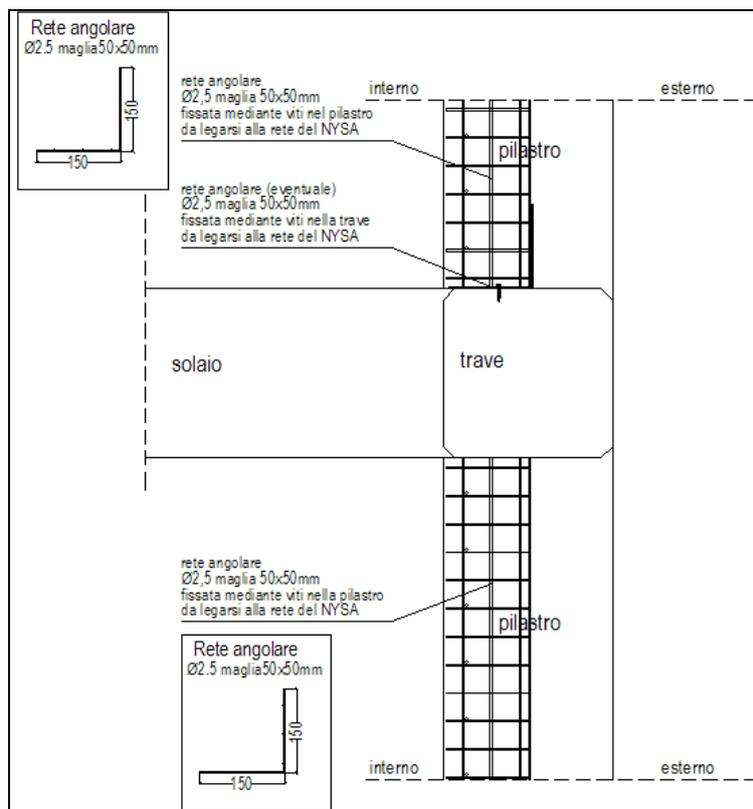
Fase 1 – Caso B: sezione verticale del collegamento.
